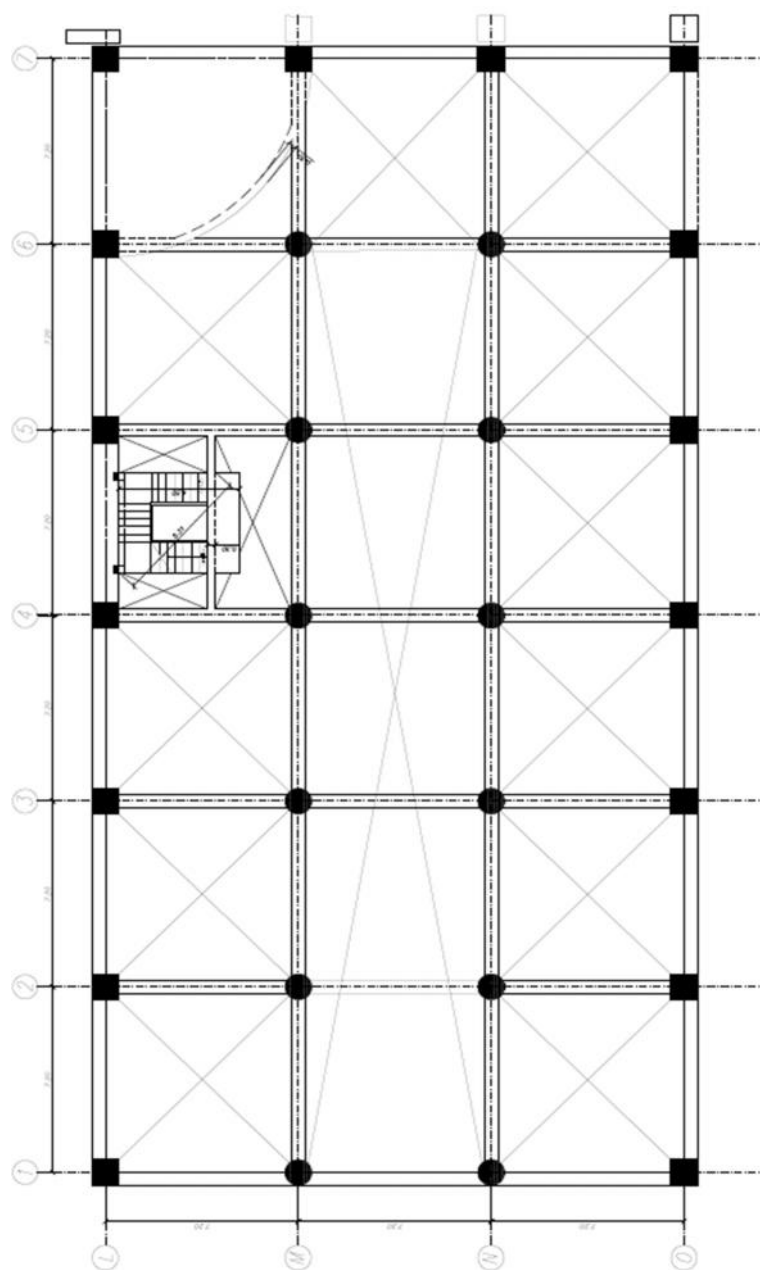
Planta estructural N+3.96, Gobernantes
